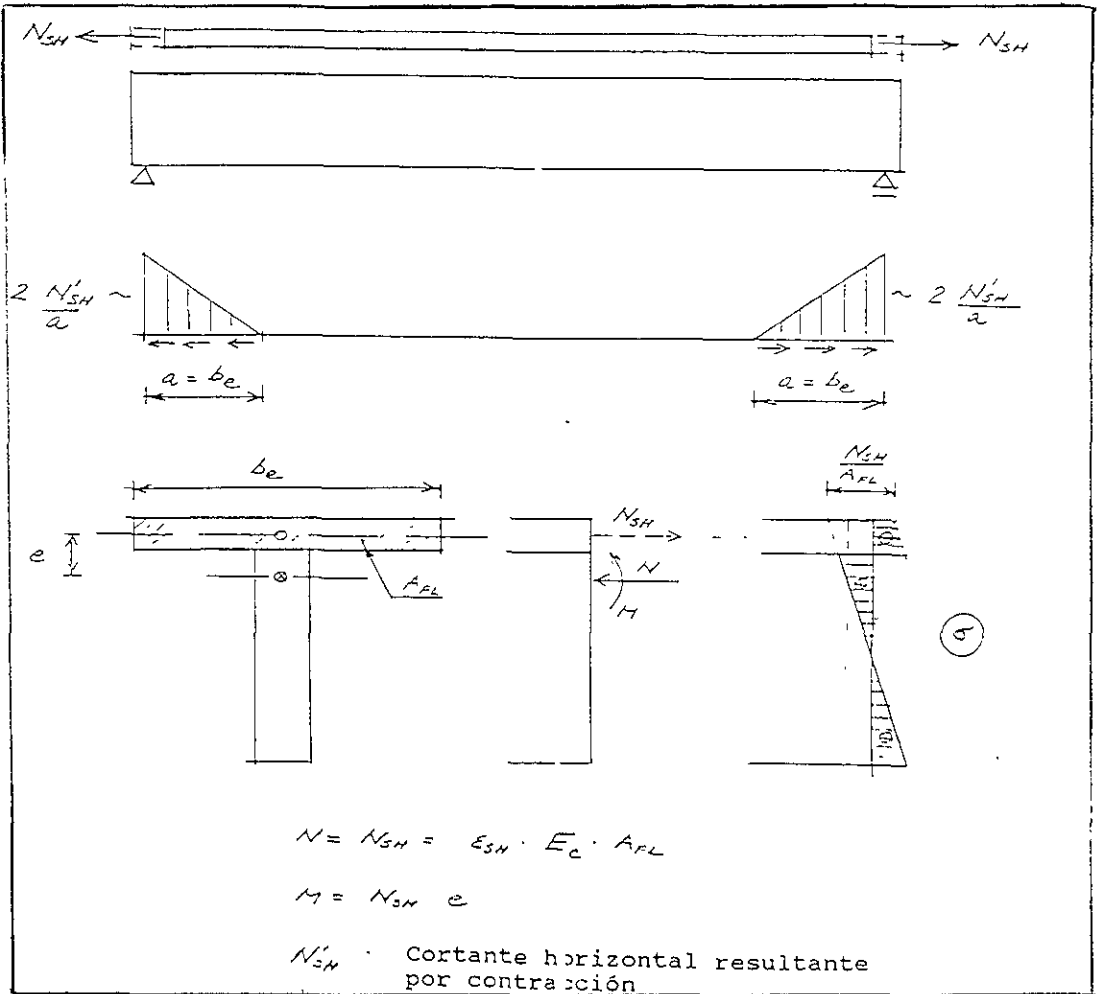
Nueva sobrecapa de concreto. Contracción.
